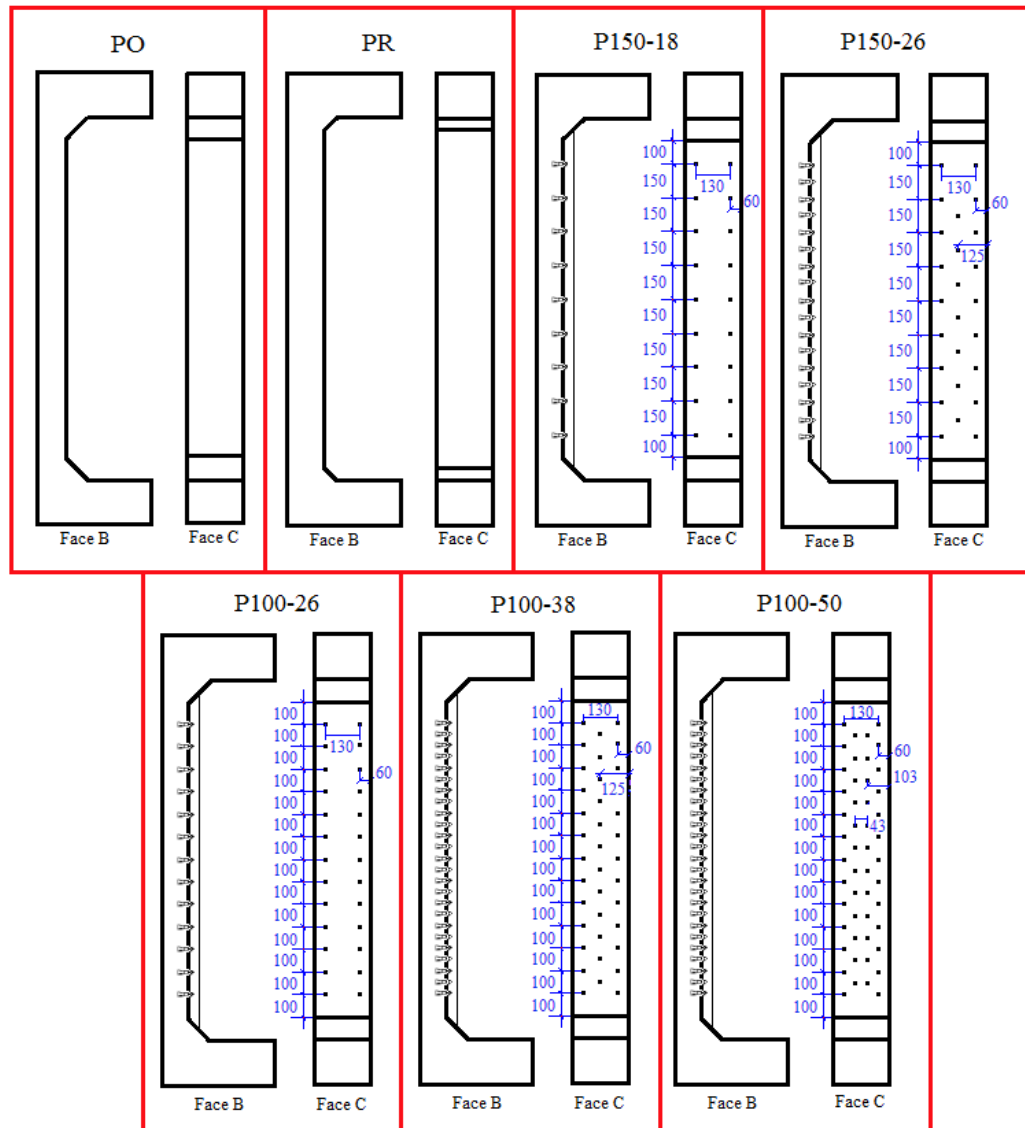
Mapeamento da posição dos conectores nos pilares reforçados para execução dos furos e instalação dos componentes
